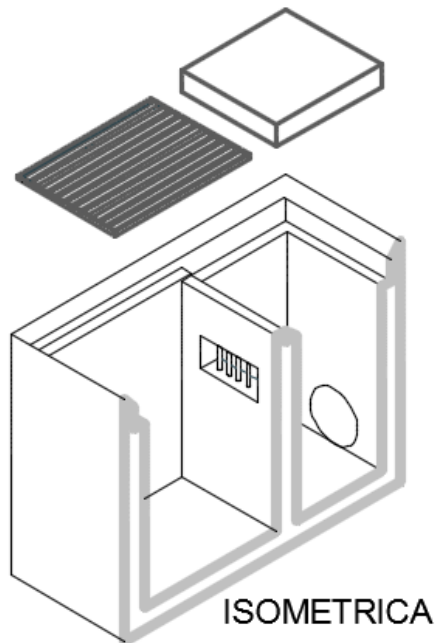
Detalle, vista 3D. (Fuente: Diseño ARINSA)
